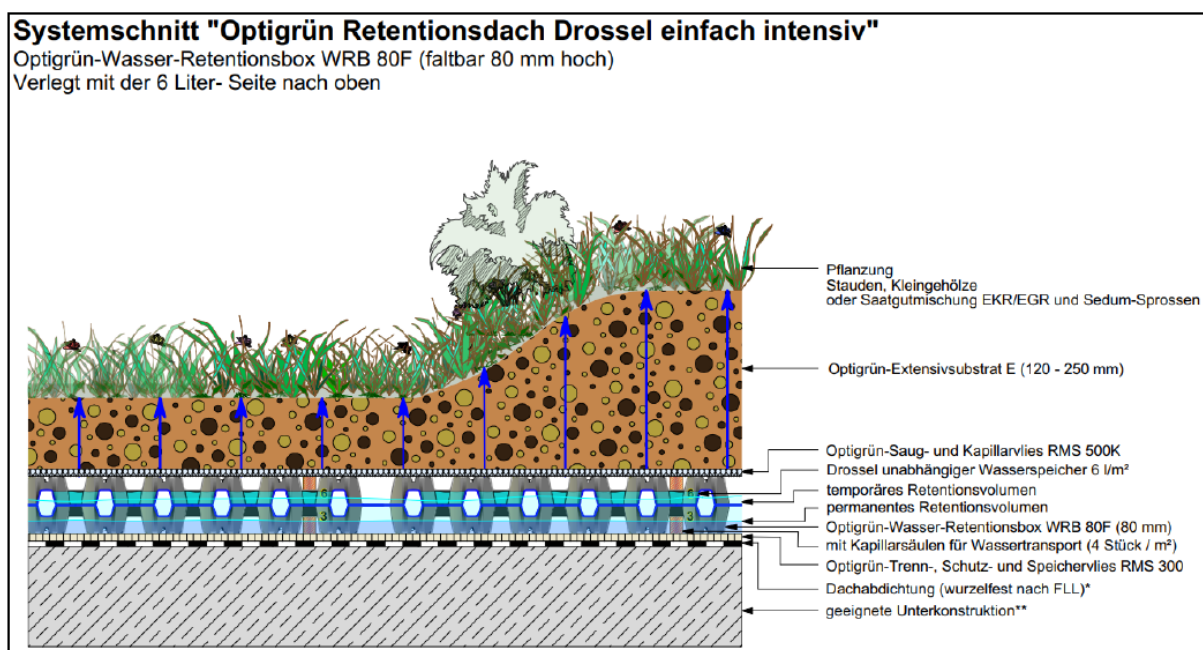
Systemschnitt eines Retentionsdaches mit Substrat
